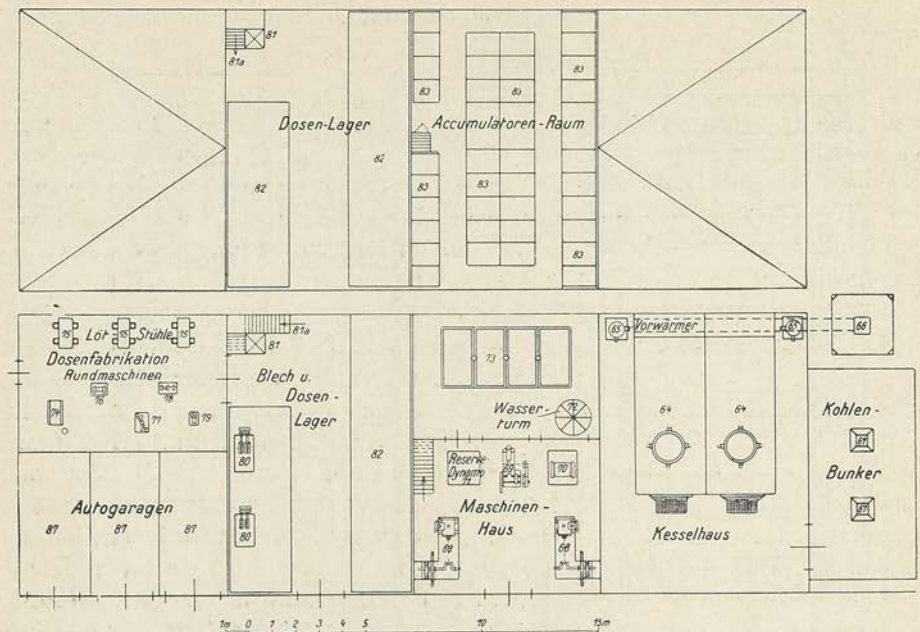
Kessel- und Maschinenhaus. Obergeschoß und Erdgeschoß.
